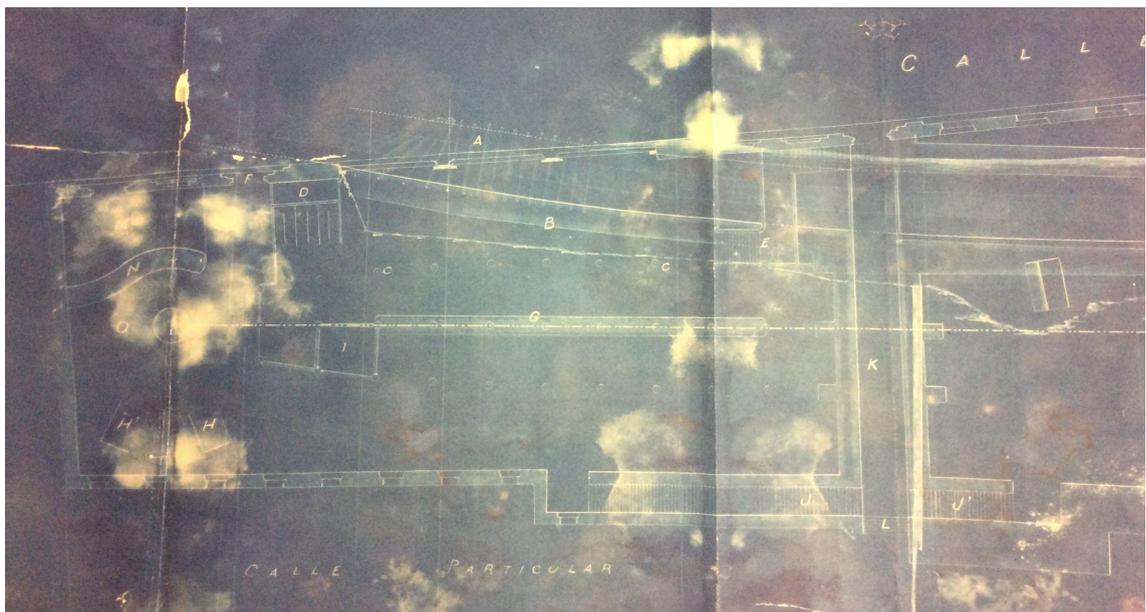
Planta baja (vestíbulo) según el proyecto de 1896. Archivo Histórico Foral de Bizkaia.
